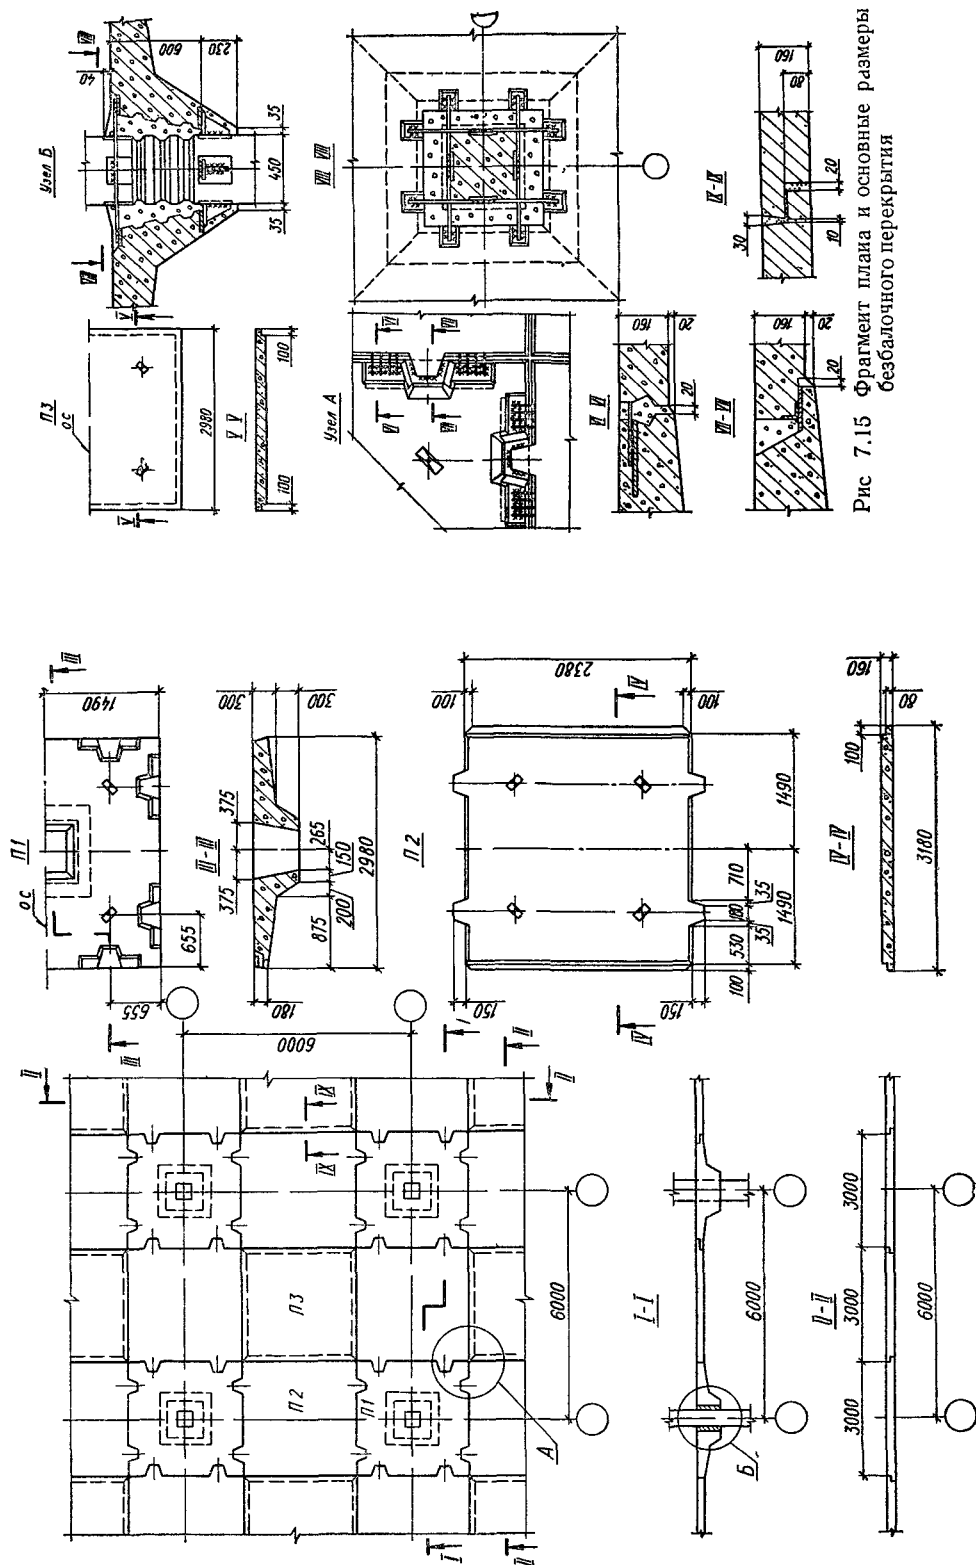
Фрагмент плана и основные размеры безбалочного перекрытия
